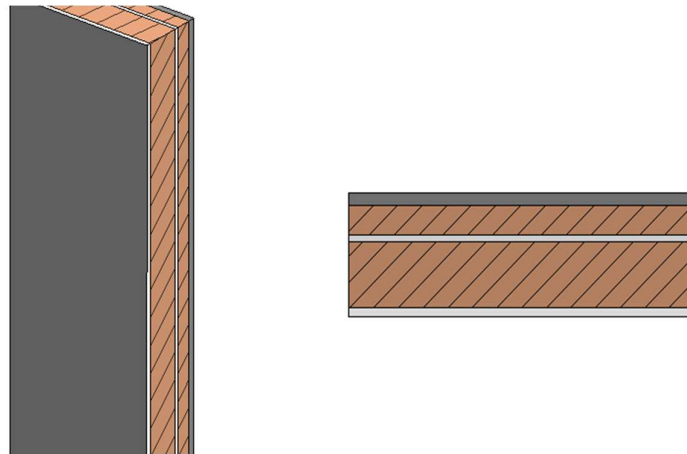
Vista en 3D y en planta del Muro 3.
